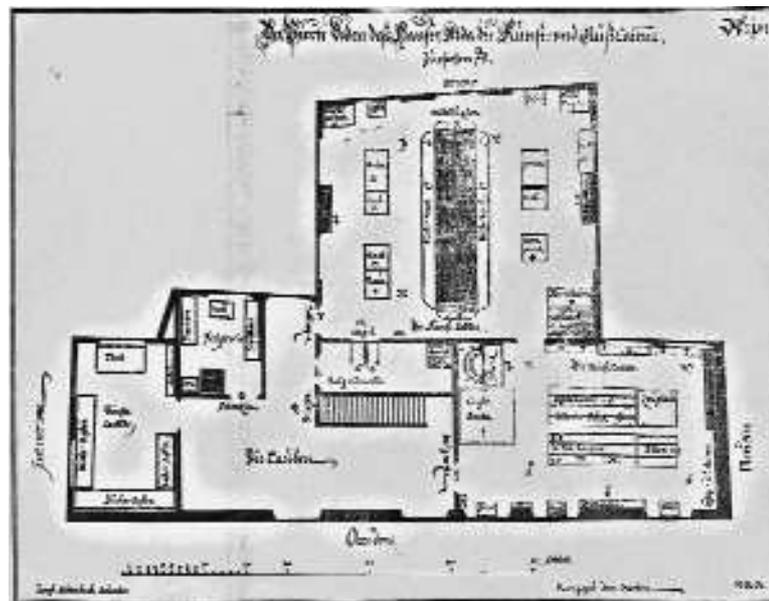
Furttach d. Ä. Privathaus, Grundriß des vierten Obergeschosses, 1641
